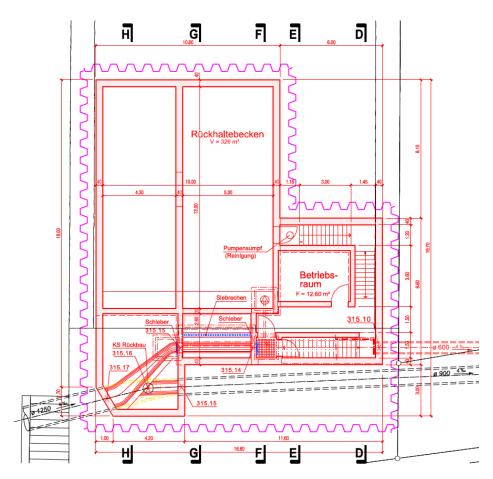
Grundriss des MWB an der Baselstrasse auf der Parzelle 178 (Gemeinde Grellingen).
